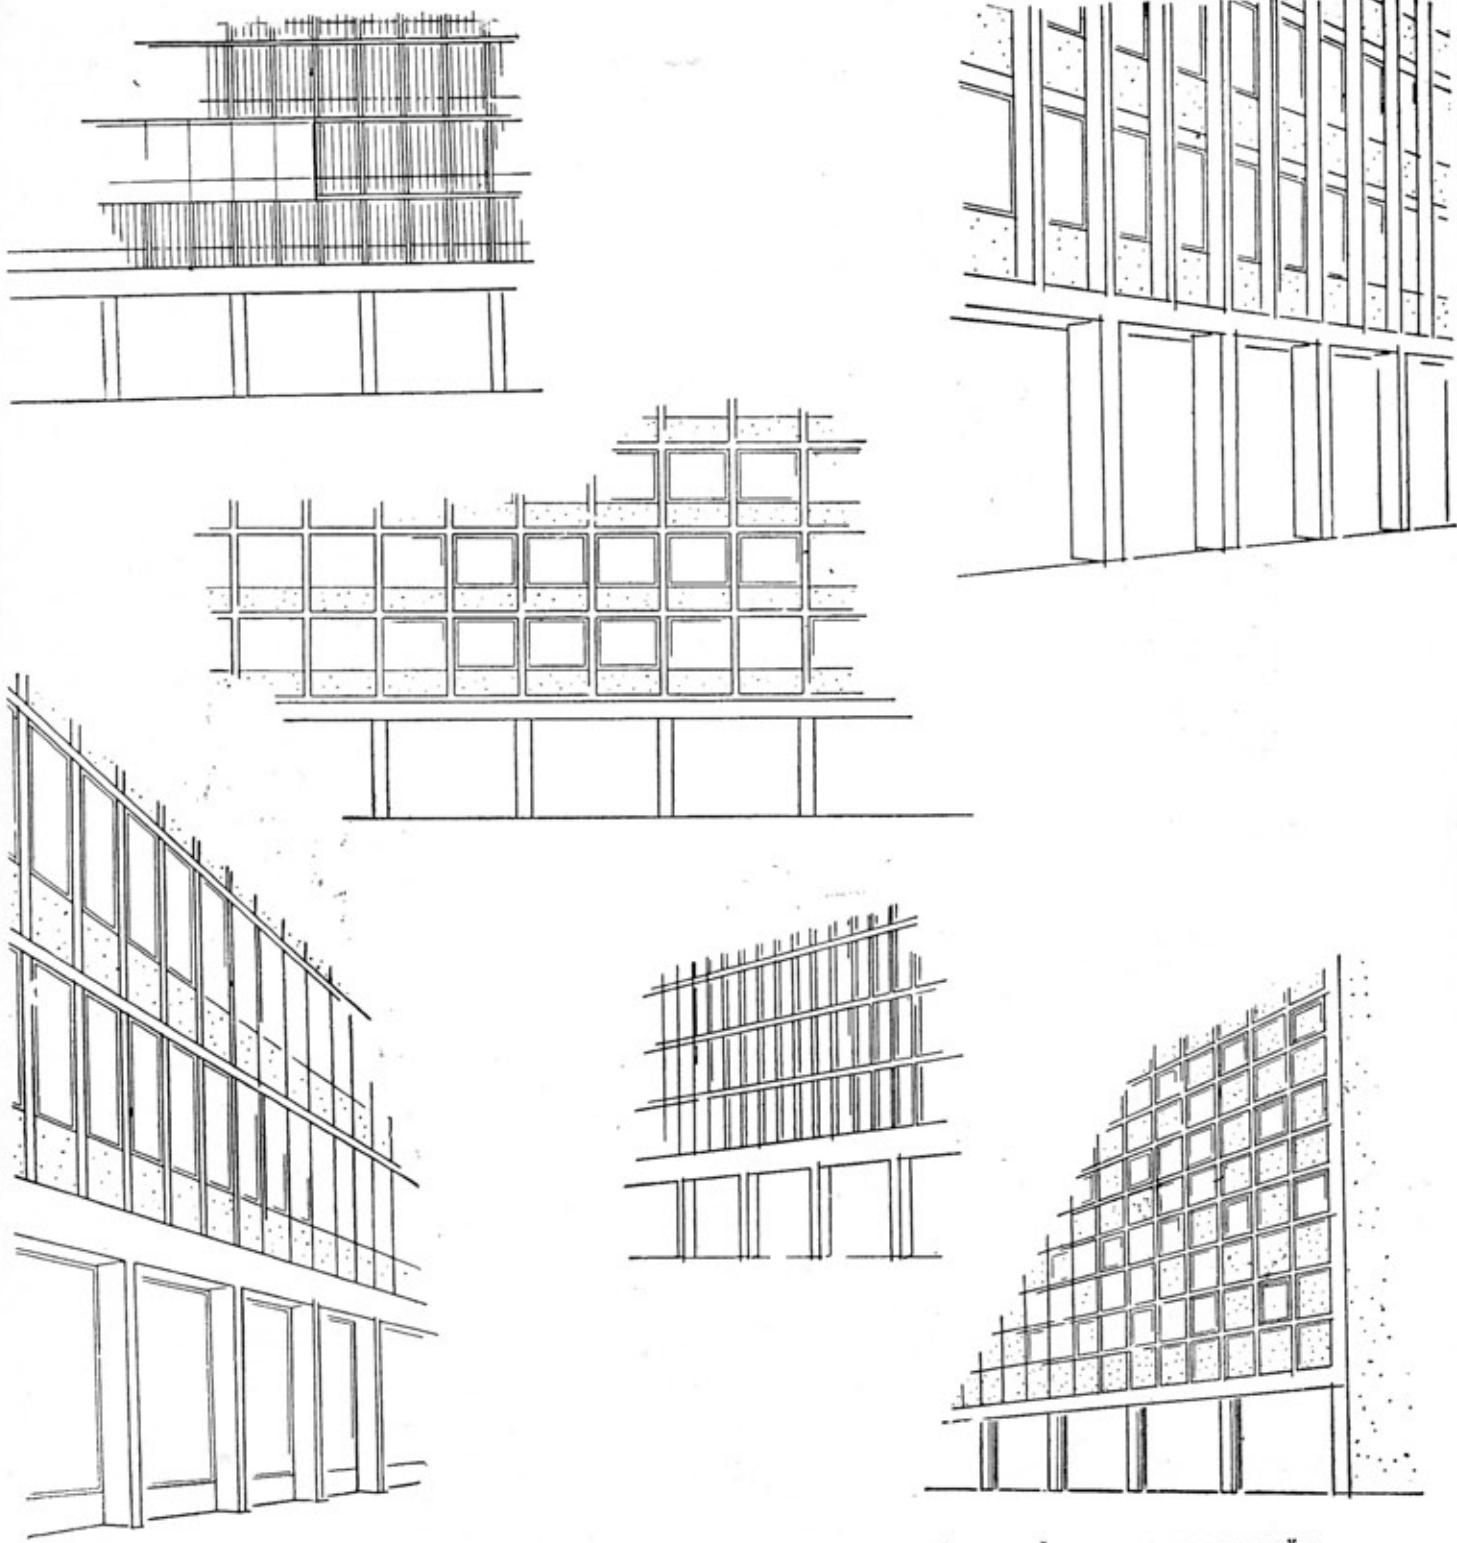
Ранд-балка над первым этажом служит переходом от частой сетки фасада верхних этажей к широкому шагу между колоннами первого этажа
